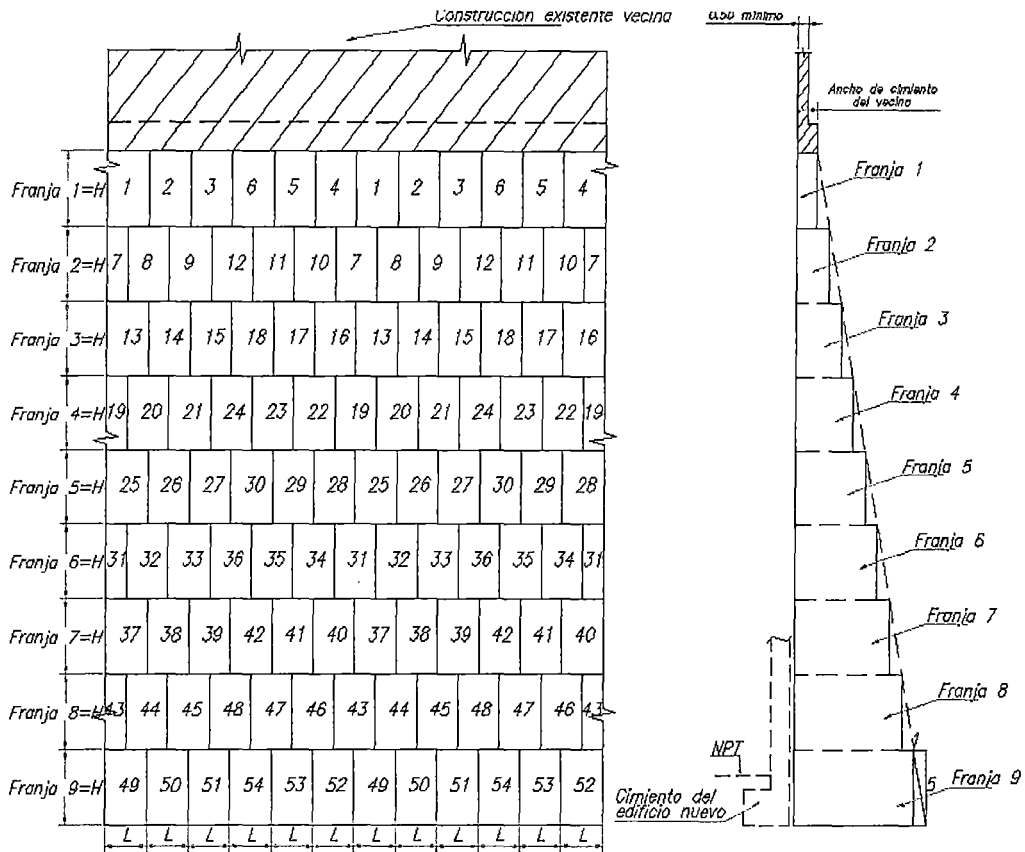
Esquema de calzaduras propuesto proyecto NEO 10. (Elaborado por el autor)
